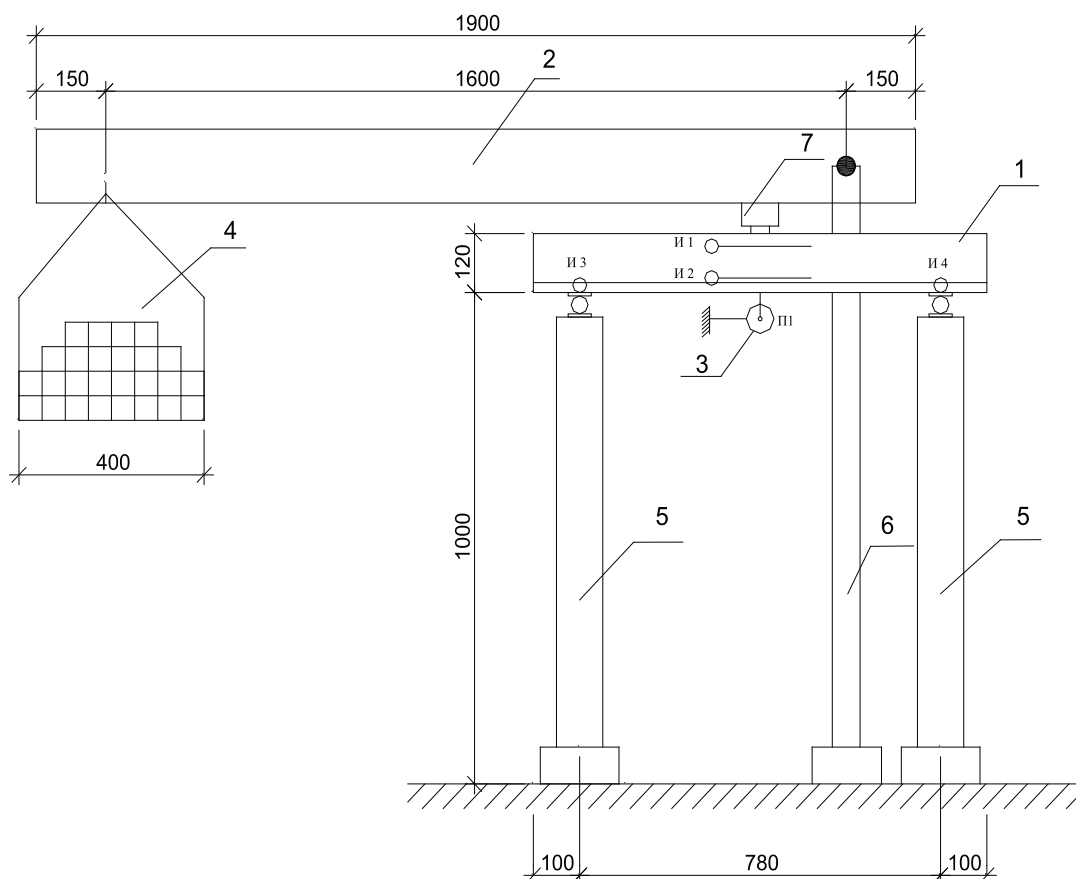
Установка для испытания балок при длительных нагрузках: 1 – опытная балка; 2 – рычаг из швеллера; 3 – прогибомер; 4 – металлические грузы; 5 – стойки из металлических труб; 6 – стойки из швеллера; 7 – динамометр
